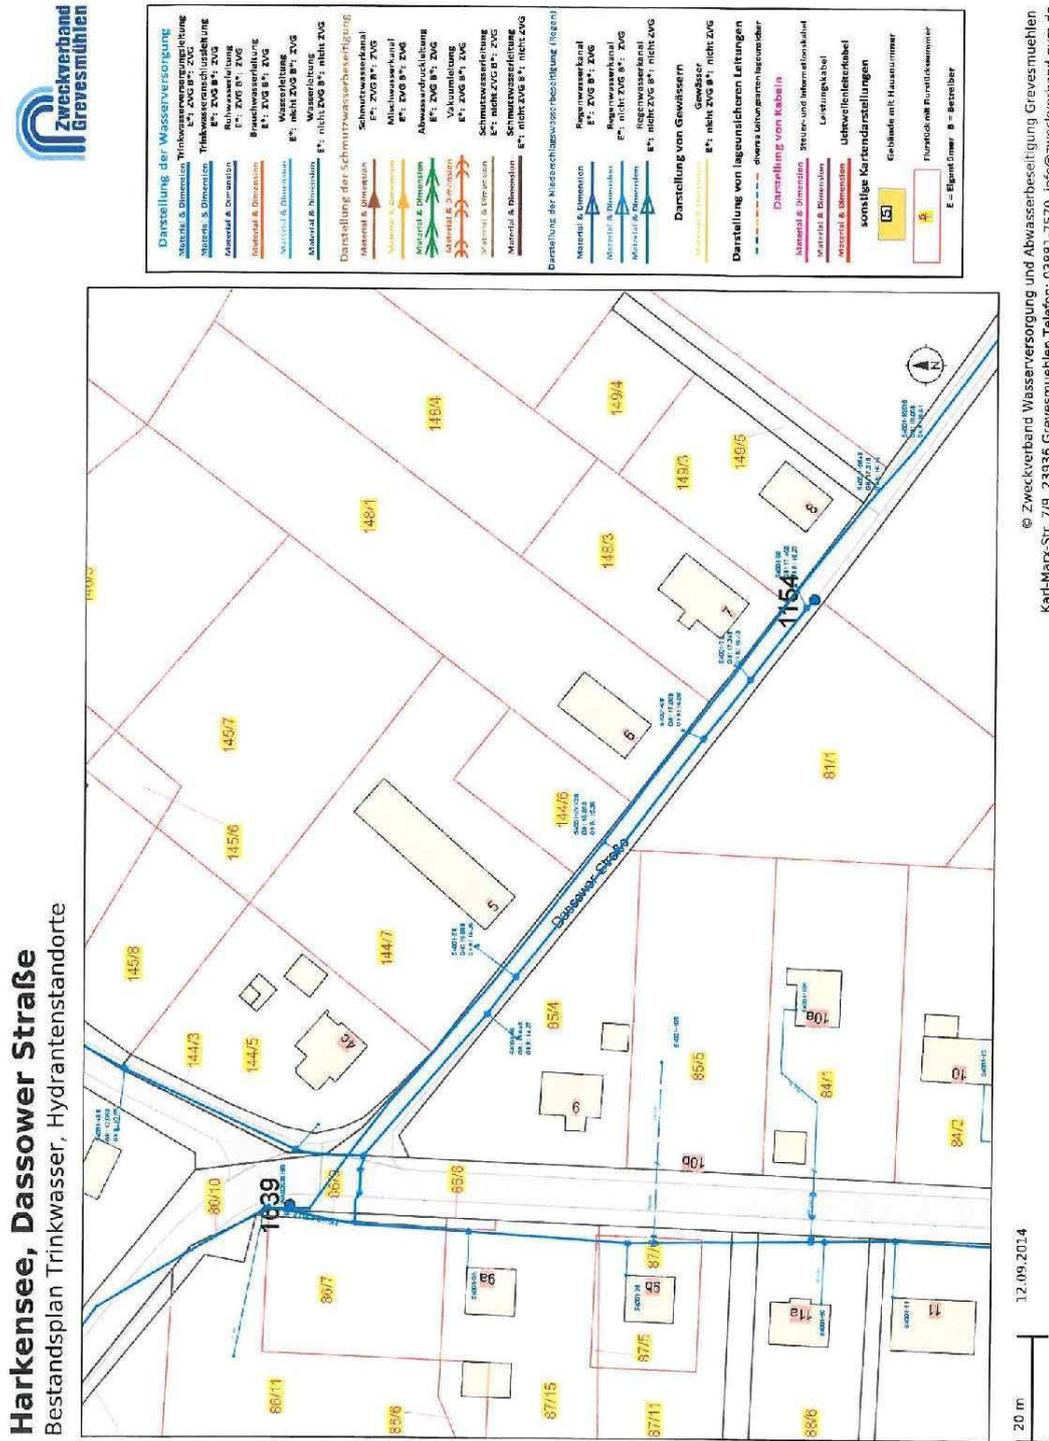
Hydrantenstandorte (Quelle: Zweckverband Grevesmühlen)
